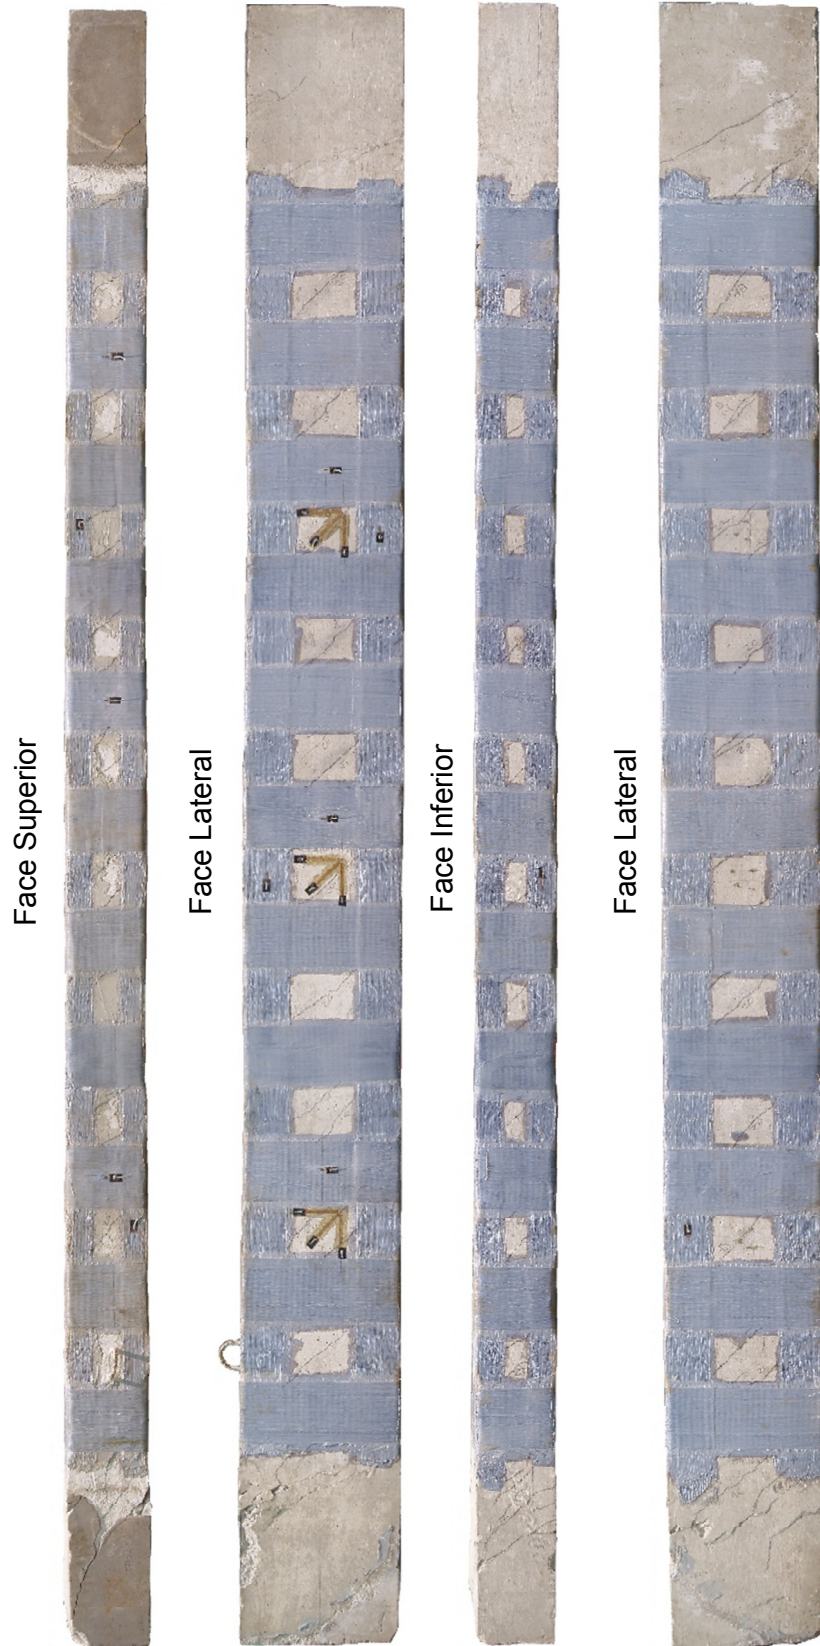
Configuração das fissuras da viga VTL3.
